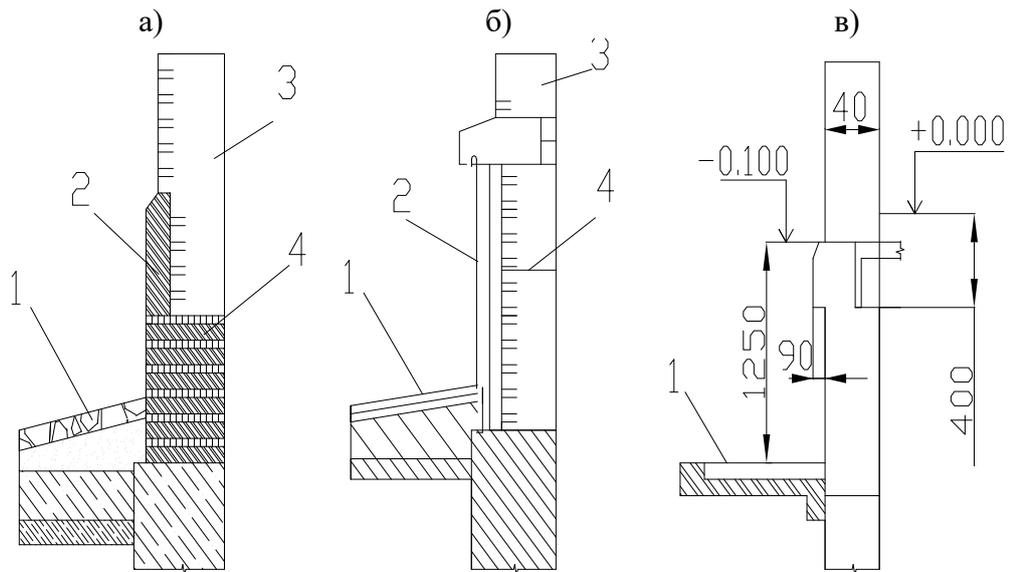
Конструктивные элементы фасадов: а – коколь, облицованный кирпичом; б – то же, плитами; в – то же, из крупноразмерных элементов; 1 – отсotka; 2 – облицовка; 3 – стена; 4 – гидроизоляция.
